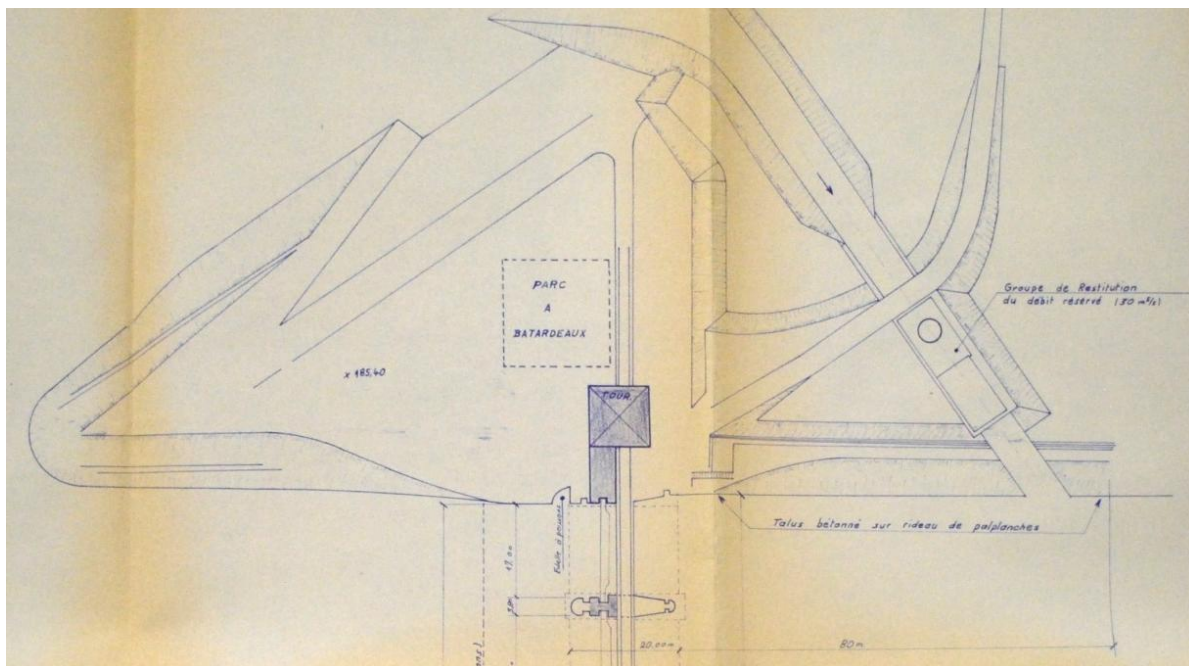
Plan du groupe de restitution (Archives de Cusset)
